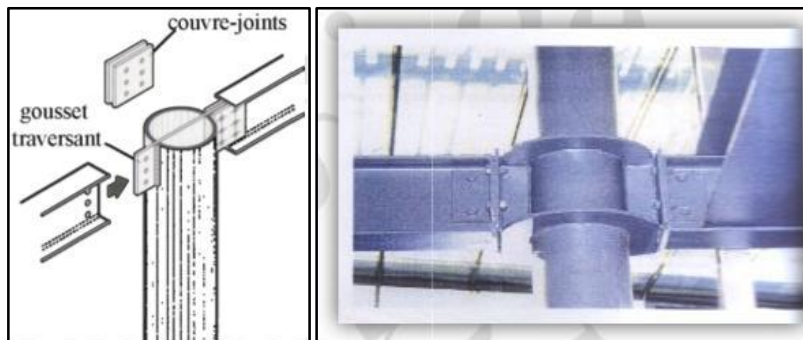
système de liaison Poteau/ poutre Source : (Semahi, 2008 :81)
